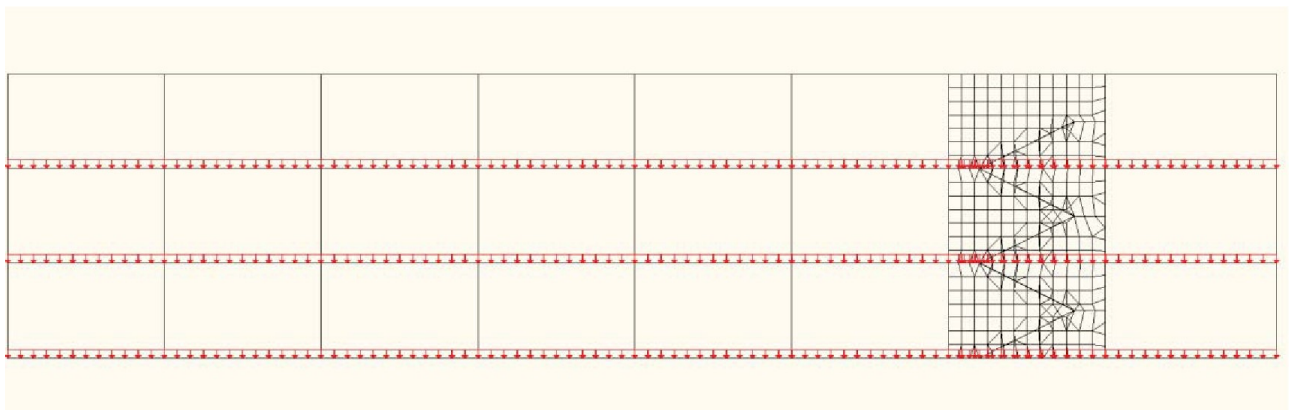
Схеми завантажень будівлі від ваги перегородок
